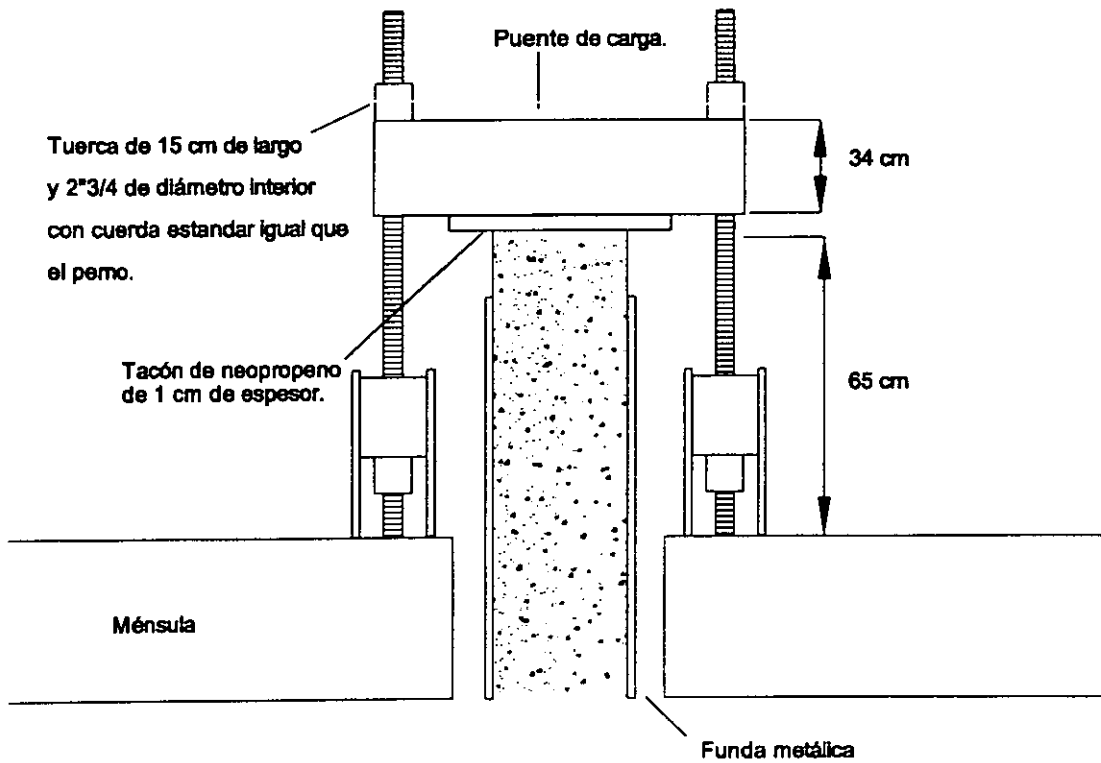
Esquema de un pilote de punta con funda antifriccionante colocado en la cimentación del Palacio Nacional
